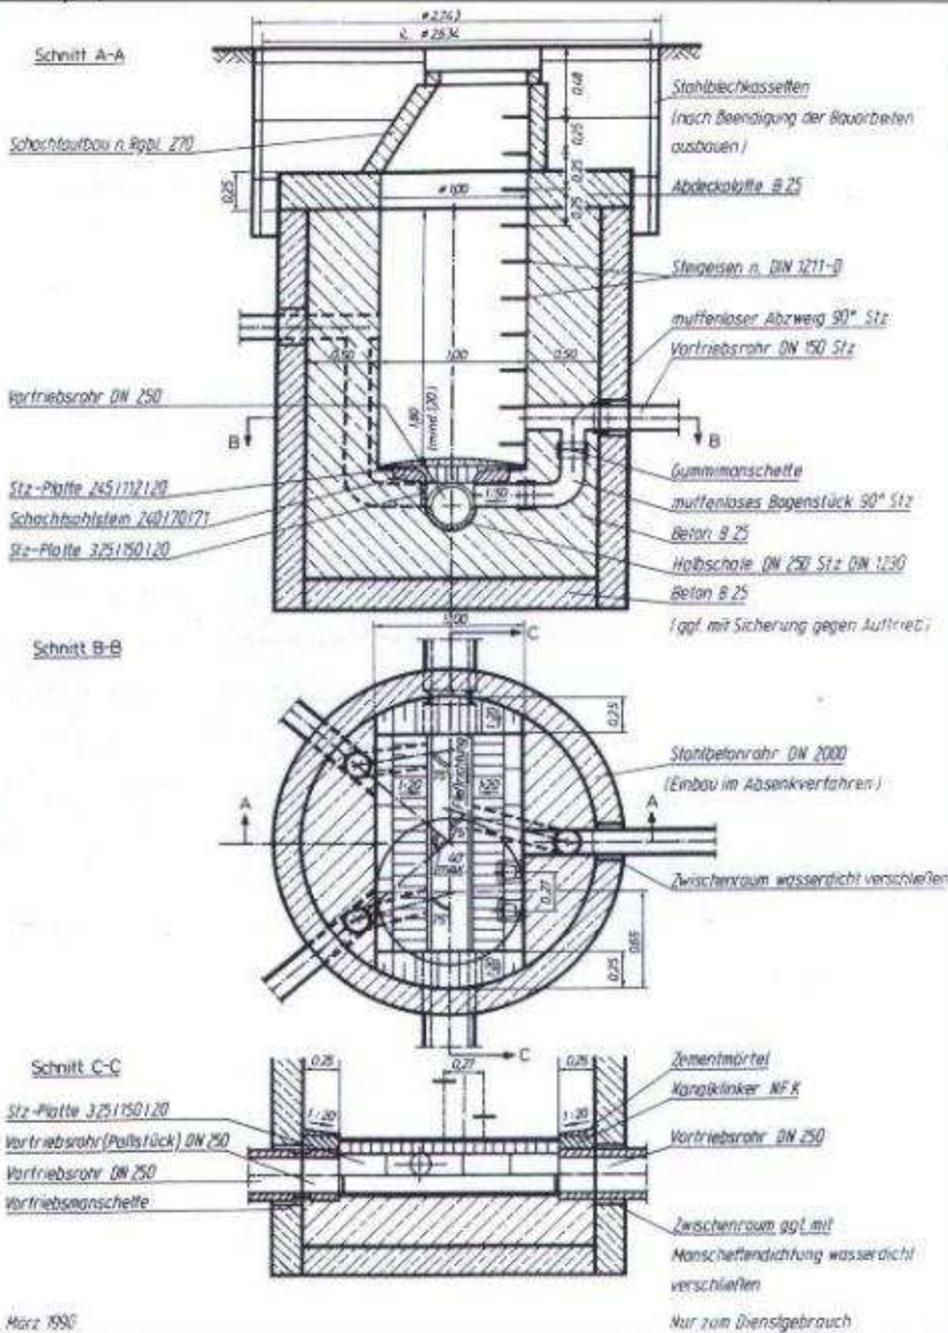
Berliner Bauweise; Start-, Zielschacht ausgebaut als Einsteigschacht
